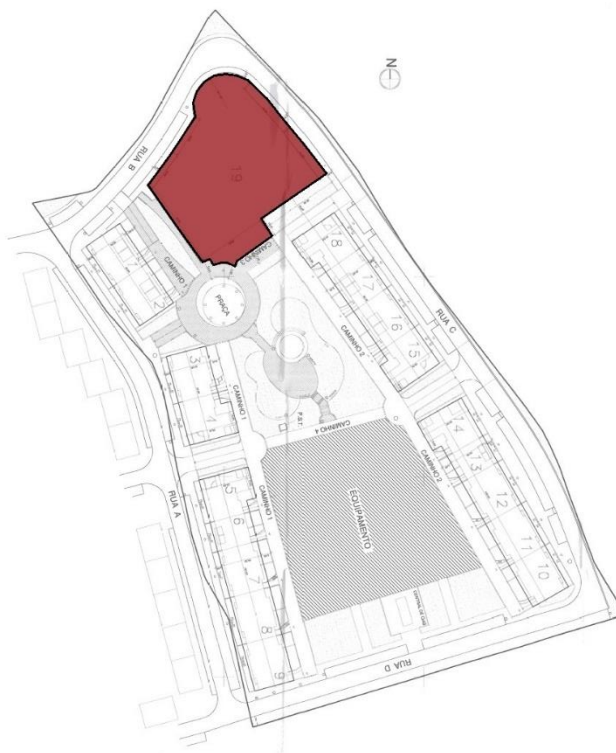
Planta do loteamento com indicação da área de intervenção.
